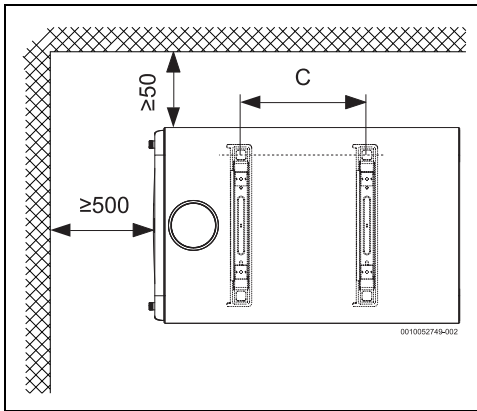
Dimensiones en mm (montaje en pared, instalación horizontal)
